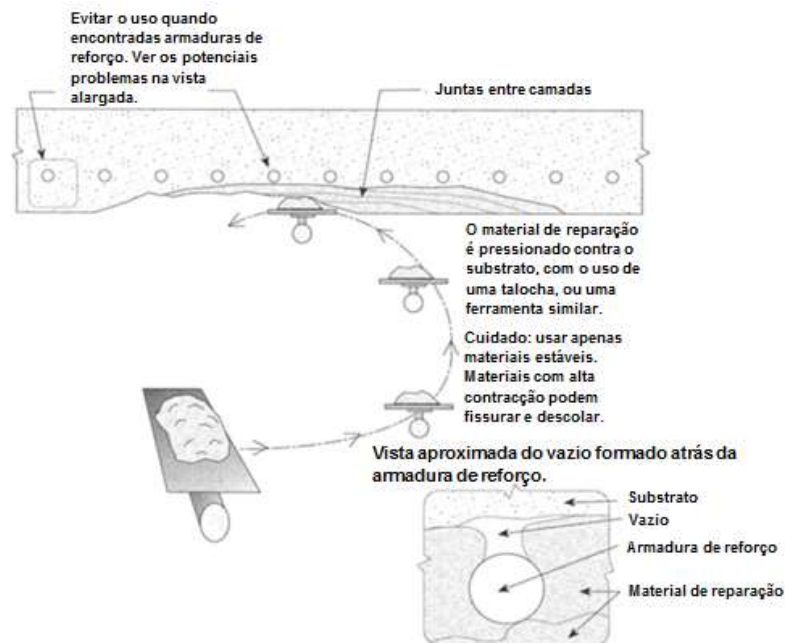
Aplicação manual, de material de reparação de betão armado (Appleton, Costa, n.d.)
